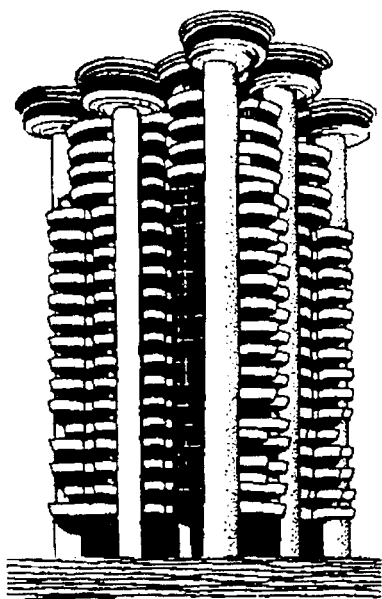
Многоэтажный жилой дом «Белые башни» из монолитного железобетона в Мадриде.
